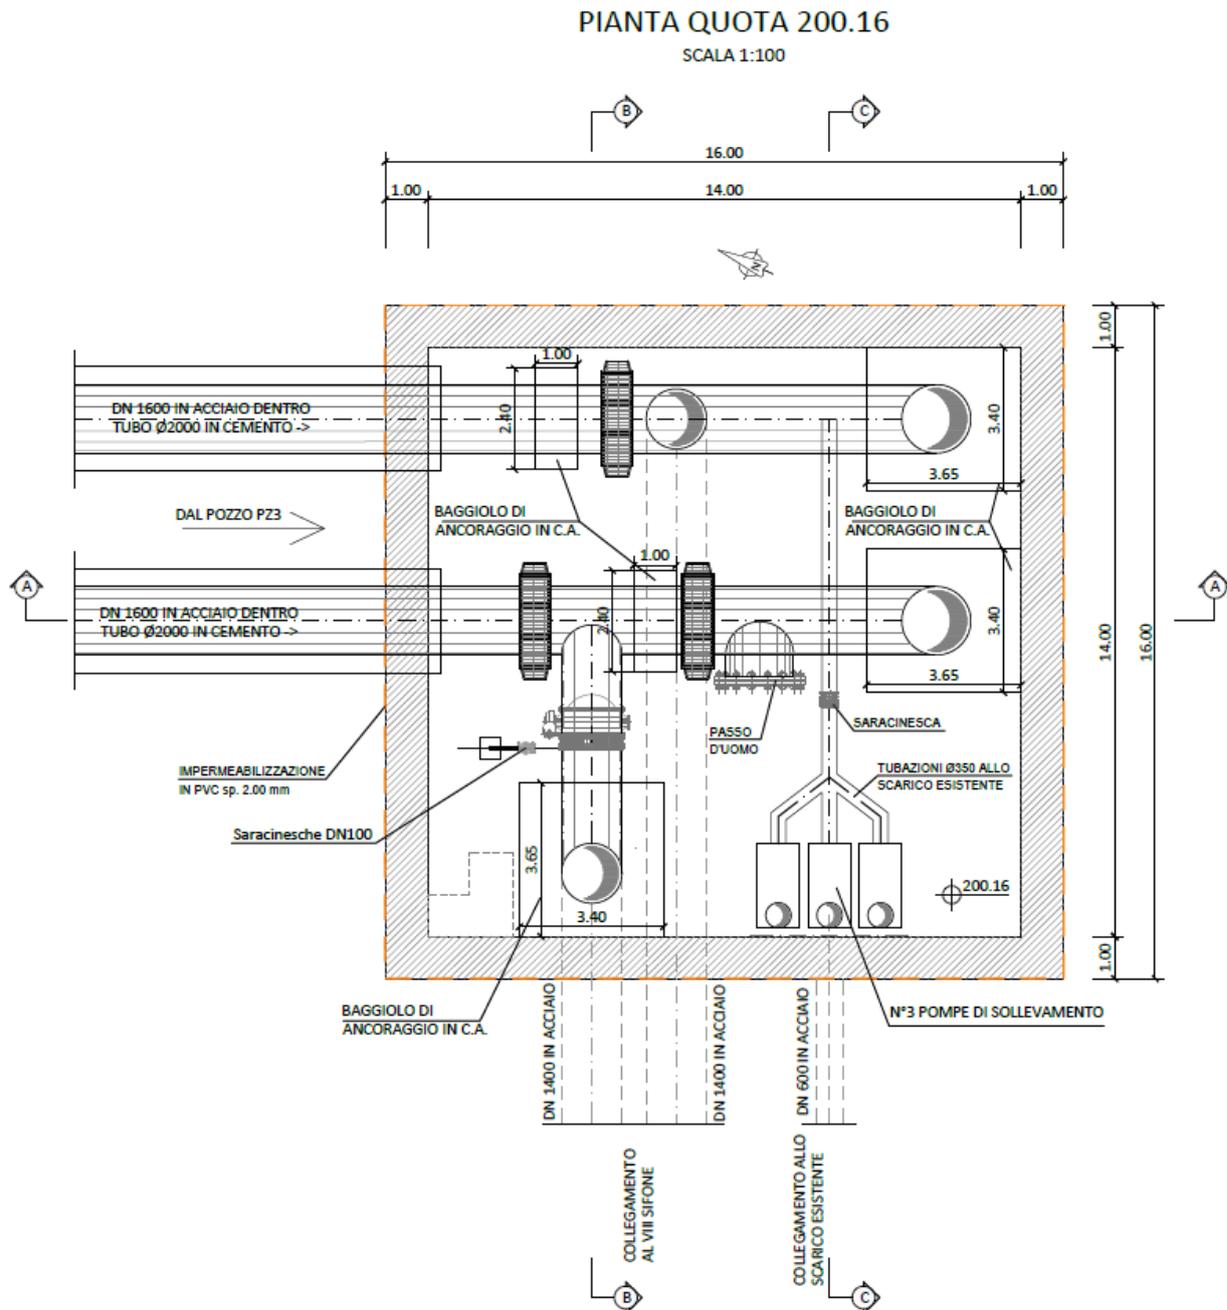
Rappresentazione in pianta del manufatto PZ4 – Sezione alla quota di ripartenza delle tubazioni verso il pozzo PZ2
